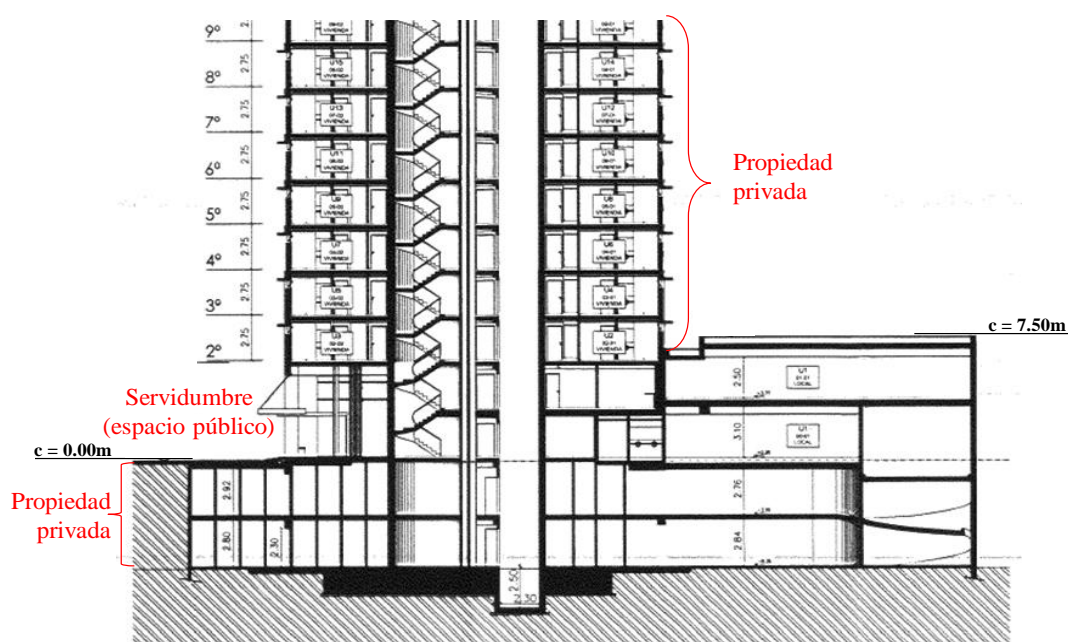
Corte longitudinal del edificio Embarcadero y alturas locales de los objetos
